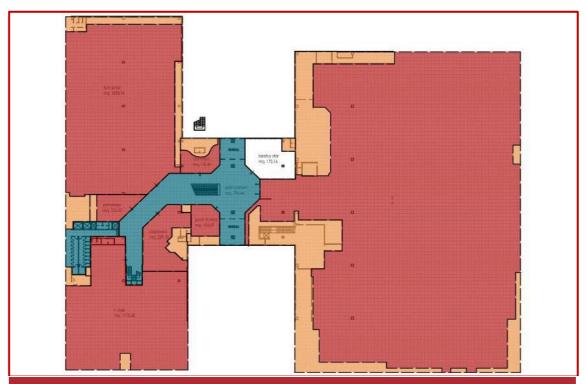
Pianta del piano terra delle dell'esercizio commerciale – non in scala
